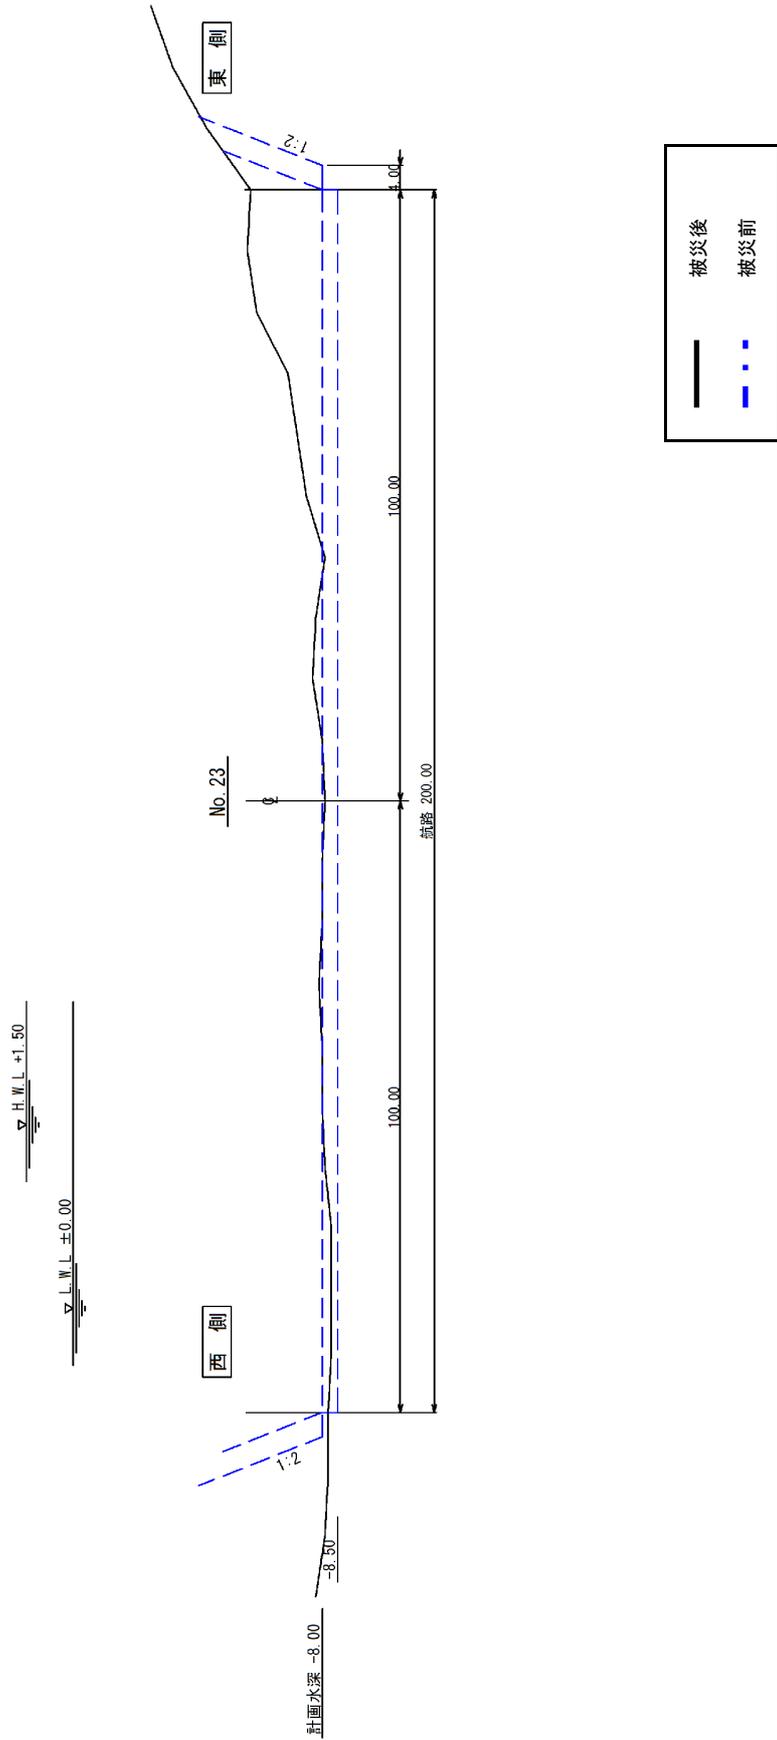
No.1 大洗港区_中央地区航路 (-8m) の断面図 (被災後)
